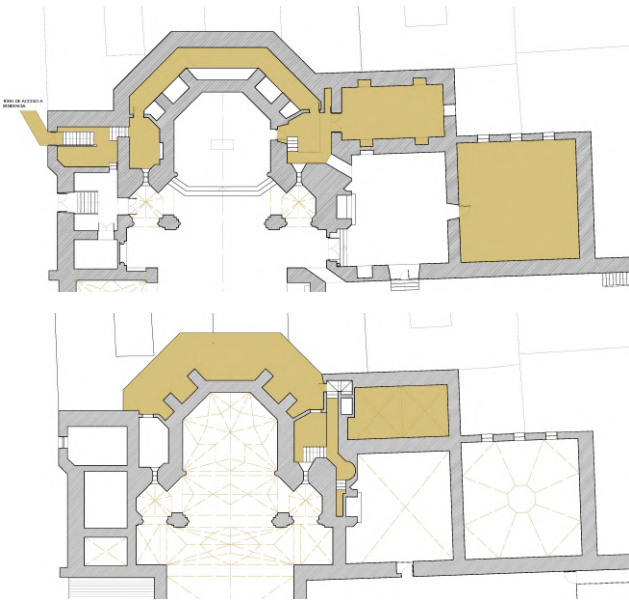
Zonas afectadas por la reforma en las plantas baja y primera. Fuente: Elaboración propia.
